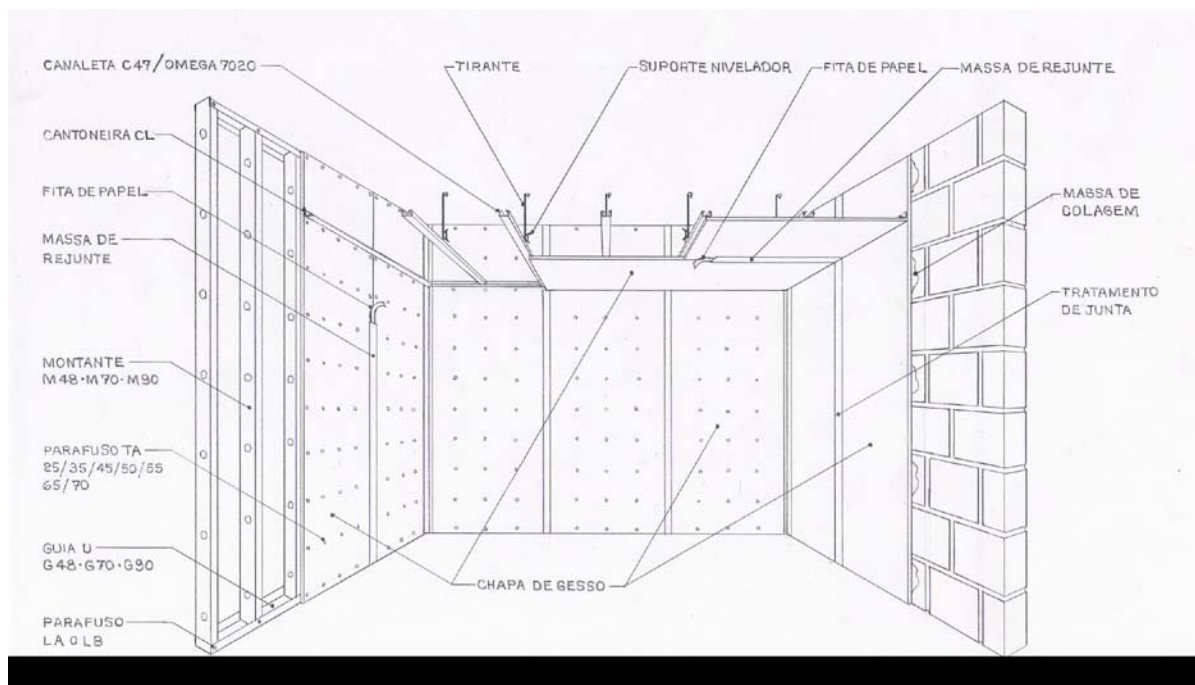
Ilustração do sistema construtivo em chapas de gesso para *drywall
